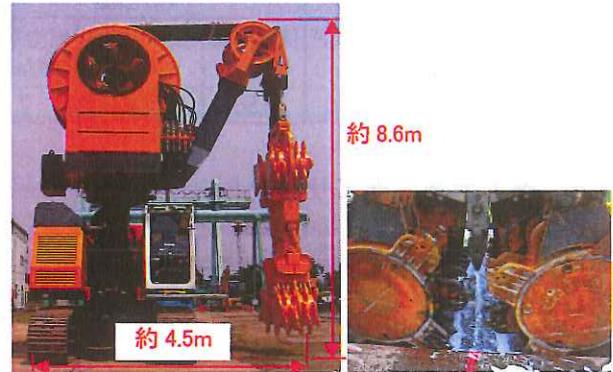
施工機械¹¹⁾ 写真-3.2 掘削液¹¹⁾
